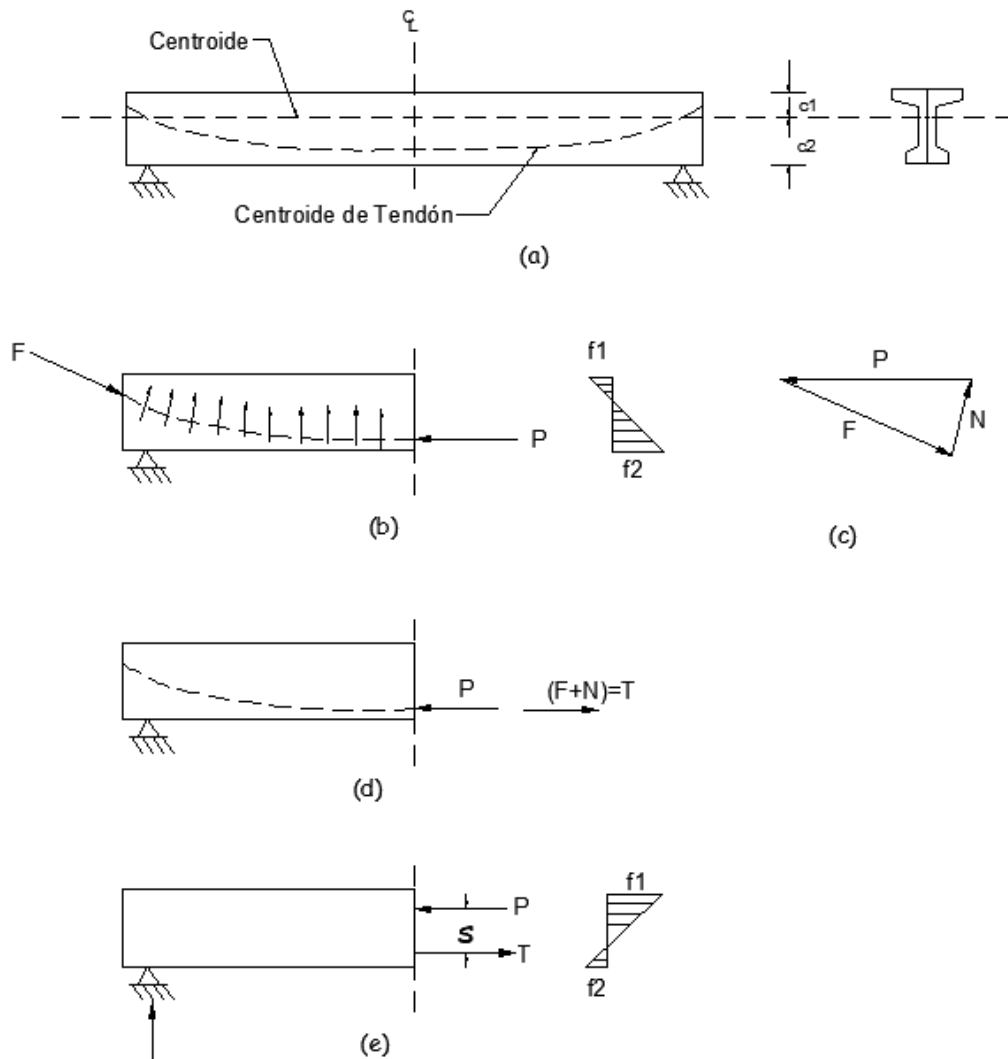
Funcionamiento de una viga postensado bajo cargas de servicio
